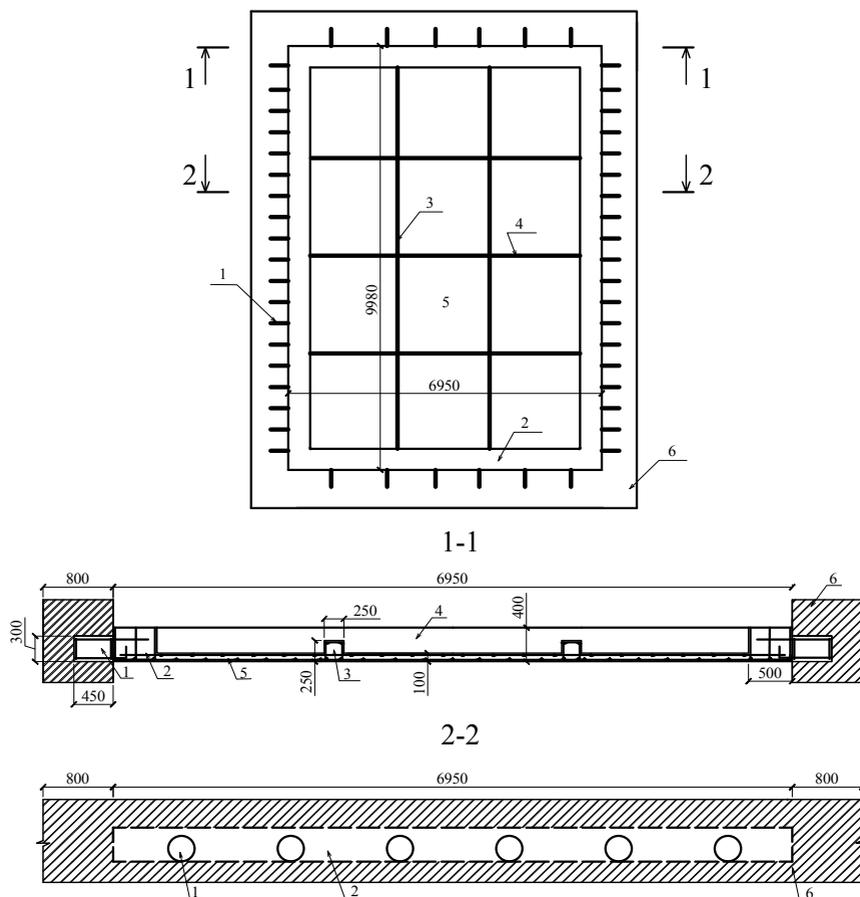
Схема выполнения разновидности реконструкции фундаментной системы путем подведения сплошной монолитной железобетонной плиты:
